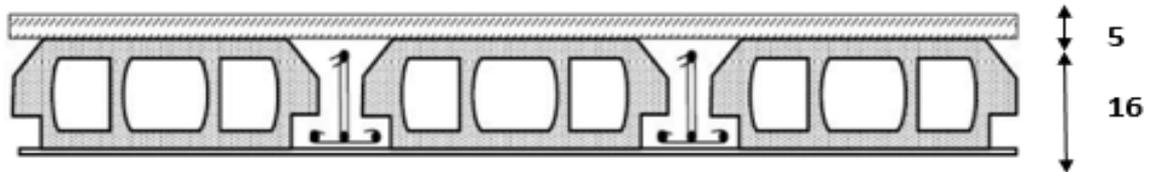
Schéma plancher l'ourdis-poutrelle (corps creux)
